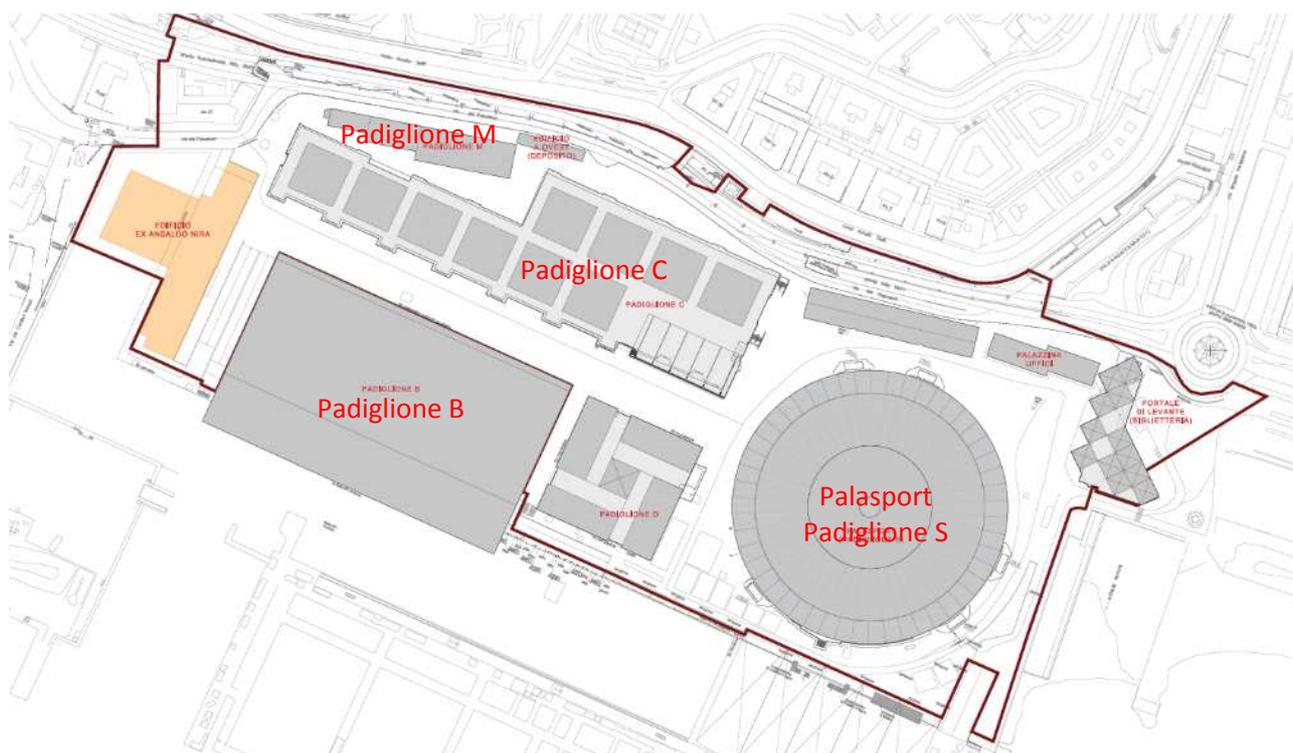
Stralcio elaborato di PUO B03. Complesso Fiera pianta coperture.
